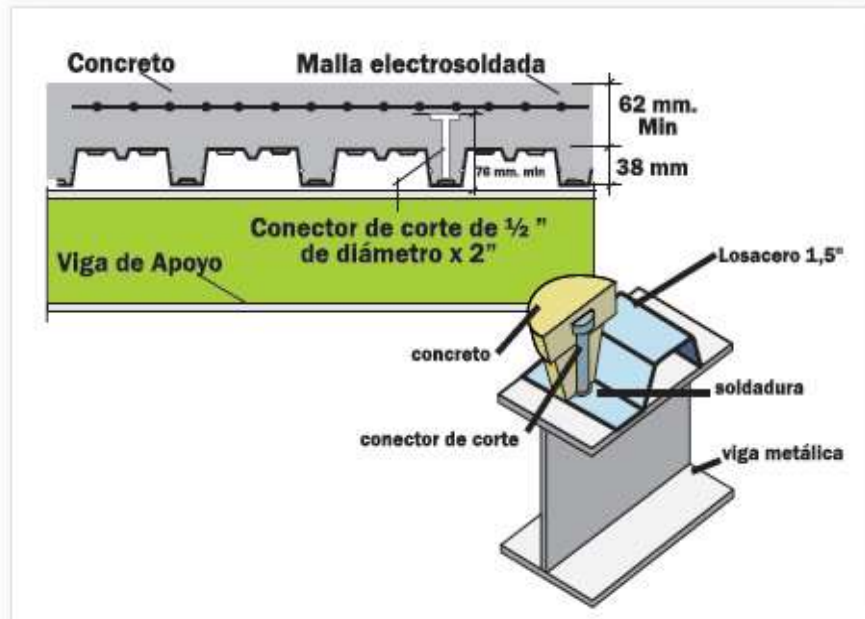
Detalle de Losacero, unión con correa metálica. Fuente: www.lamigal.com(2017)
